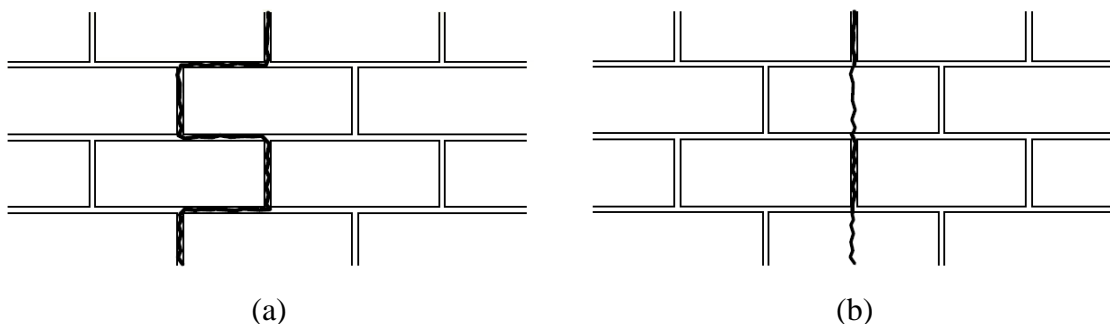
Tipos de fissuração de alvenaria por aparecimento de esforços à tração.
